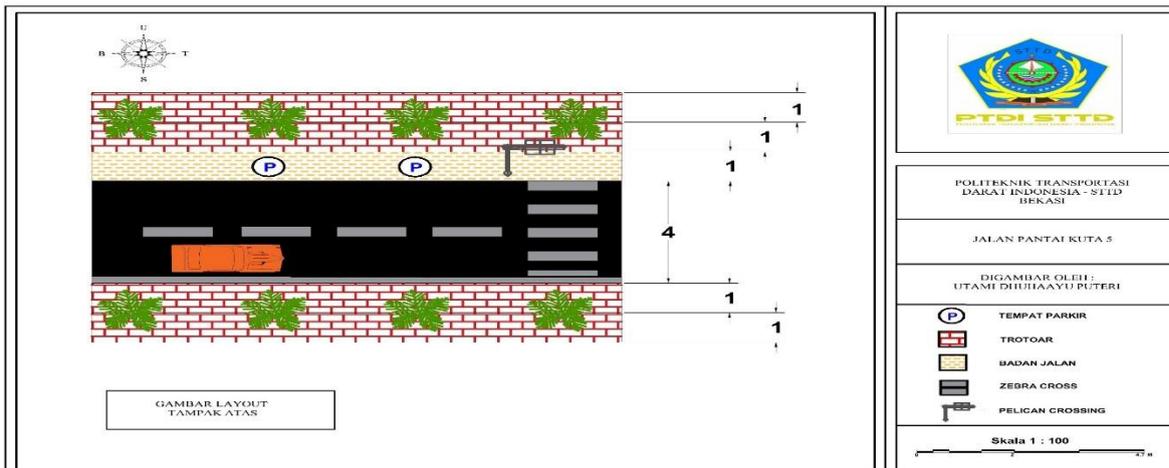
Contoh Layout Sentral Parkir Kuta
